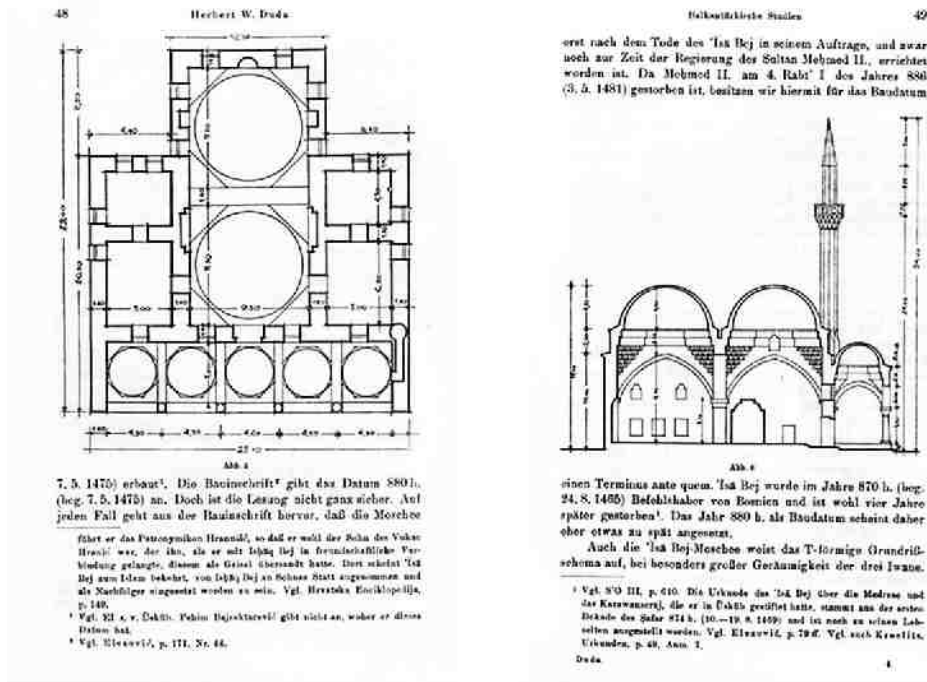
Skopje, Stiftungsbau (*İmaret*) des İsa Beg, 15. Jh., Grundriss und Schnitt in Duda 1949, S. 48f.
